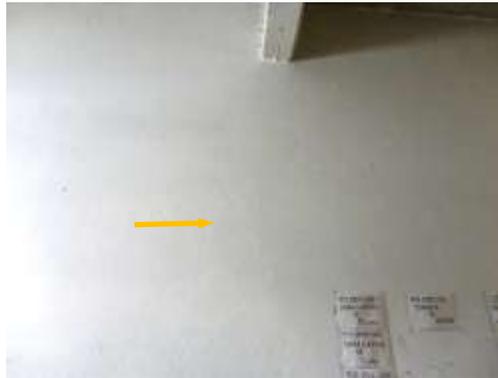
Fisura en Aplanado de yeso en muro divisorio
